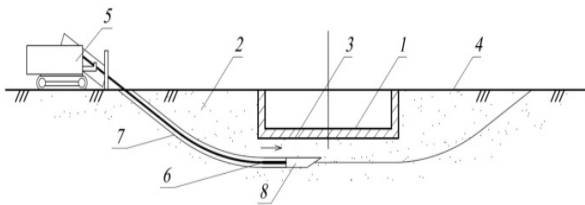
Вертикальний переріз осі напрямної свердловини: 1-споруда; 2-ґрунт; 3-підосва споруди; 4-денна поверхня; 5-бурова установка; 6-прохідницька рідина; 7-напрямна свердловина; 8-бур
